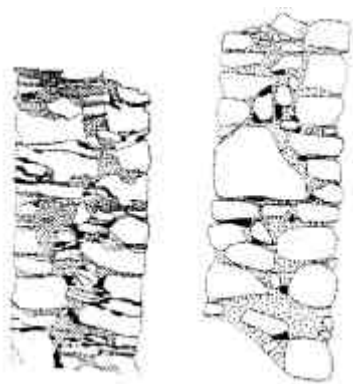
Sezioni di murature in pietra.
